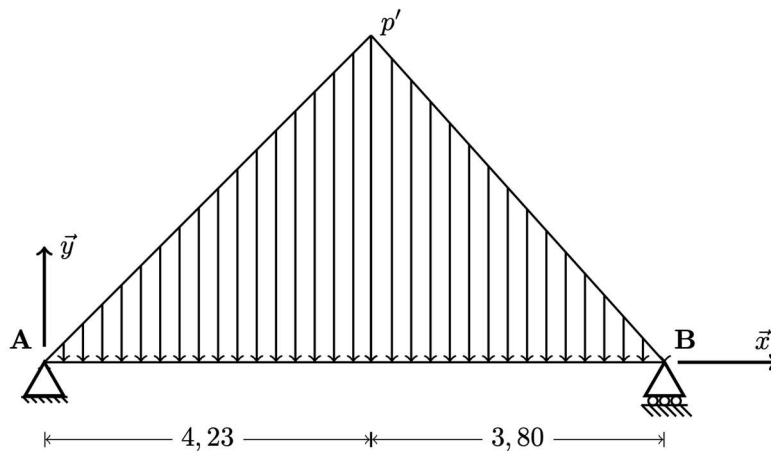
Poutre isostatique, plancher haut, reprise du poids propre du panneau de dalle adjacent
